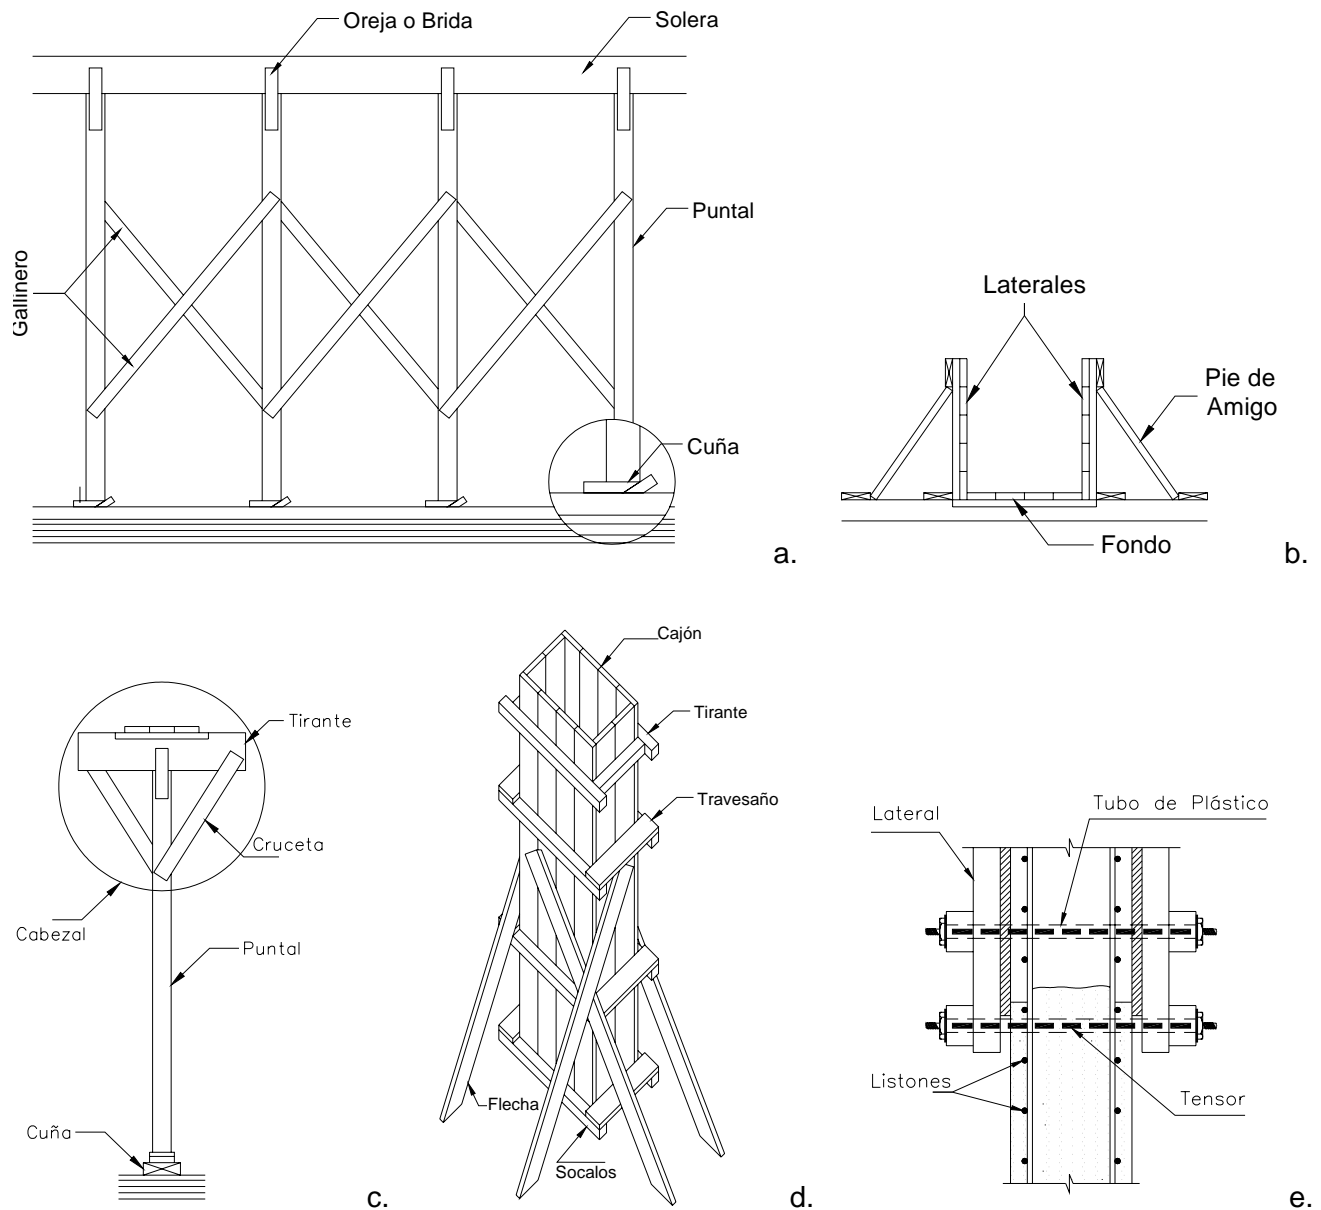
Elementos del encofrado. a. apuntalado, b. encofrado viga, c. detalle del puntal, d. encofrado de columna rectangular, e. encofrado de muro.
